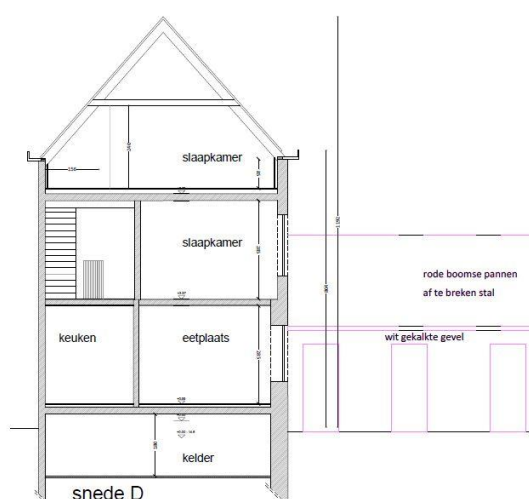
Opmetingsplan bestaande toestand met aanduiding te verbouwen gebouwen (in geel) en te slopen gebouwen (in rood)
